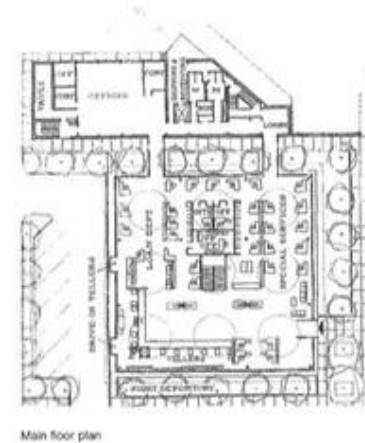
PLANTA BAJA IRWIN TRUST BANK FUENTE: [HTTPS://WWW.PINTEREST.ES/PIN/7177680644811121/](https://www.pinterest.es/pin/7177680644811121/)
